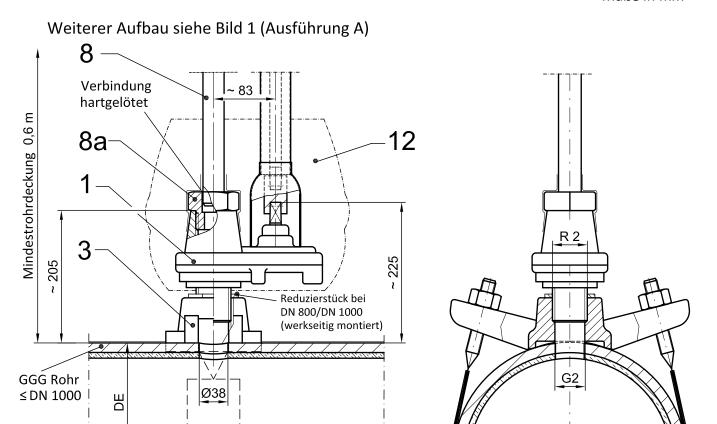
Entlüftung einer ADL aus duktilem Gusseisen ≤ DN 1000 – Ausführung B (Prinzipskizze)
